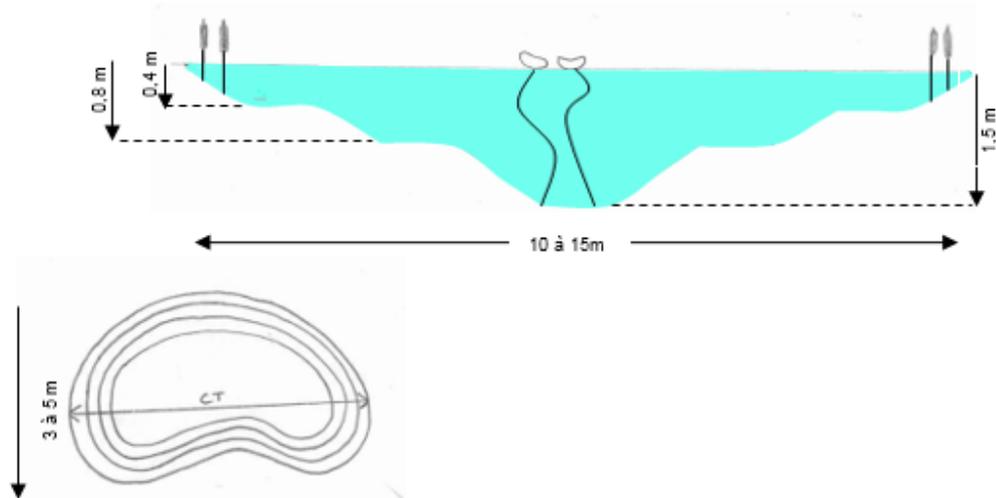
Schéma principe et coupe transversale et longitudinale d'une mare
